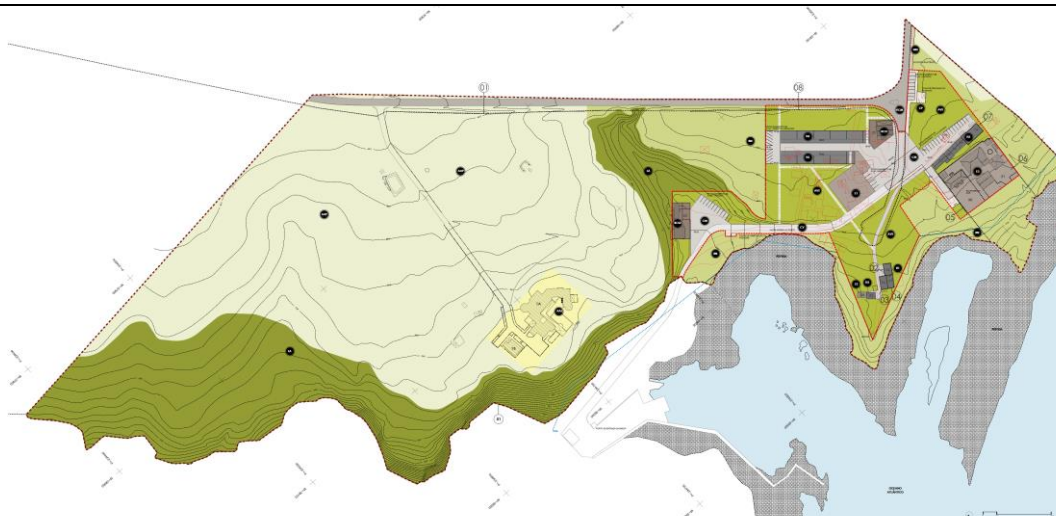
Planta de implantação do PIER (consulta planta anexa da implantação do PIER para identificação das categorias de espaço).
